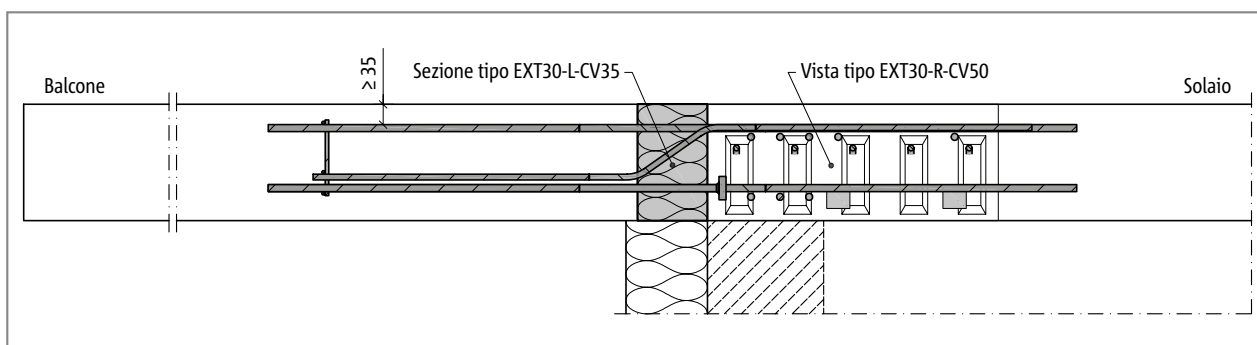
Schöck Isokorb® tipo EXT: angolo esterno con cappotto (sezione EXT-L-CV35; vista EXT-R-CV50)
